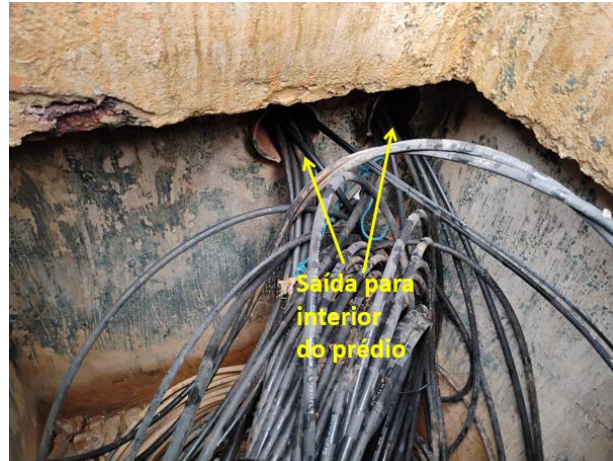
Detalhe – Caixa 3: Saída do cabeamento em direção ao interior do prédio.
